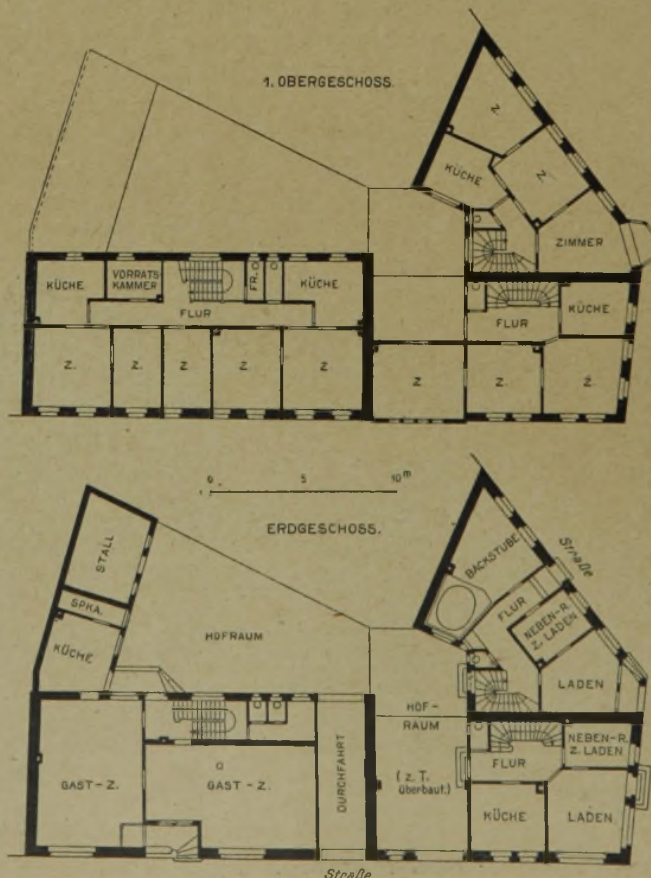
und 5. Grundrisse der Gebäudegruppe.
